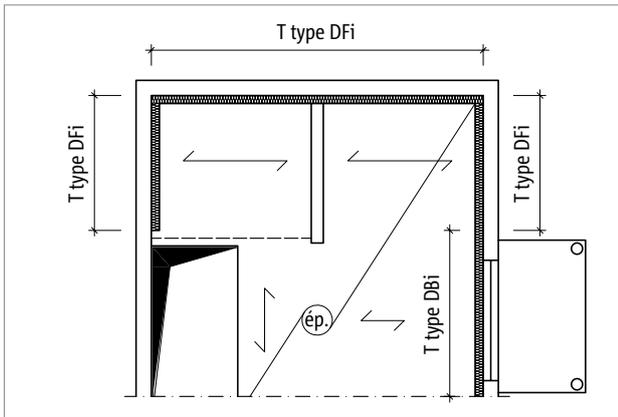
Schöck Rutherma® T type DF*i* : utilisation entre la dalle et la façade
